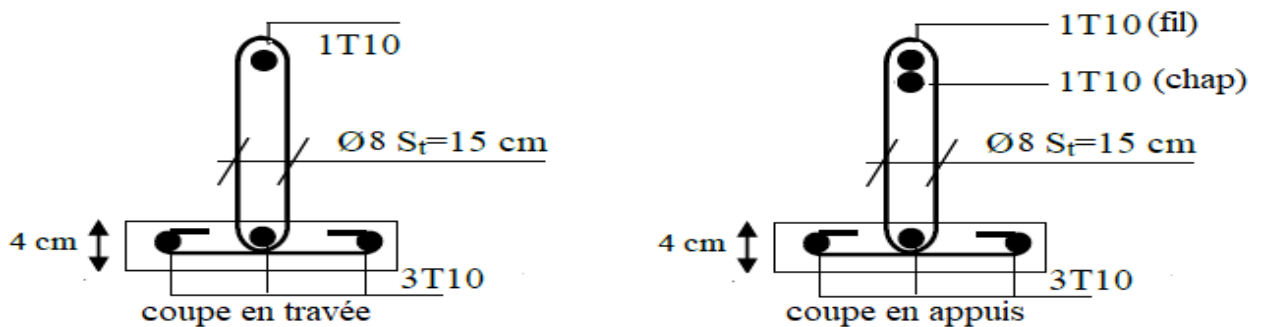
Schéma de ferrailage des poutrelles intermédiaires Plancher terrasse
